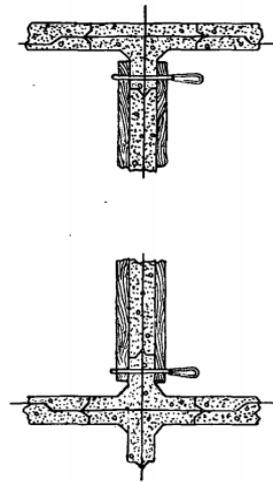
Sistema Noreña para muros (Miquel, 1928)
